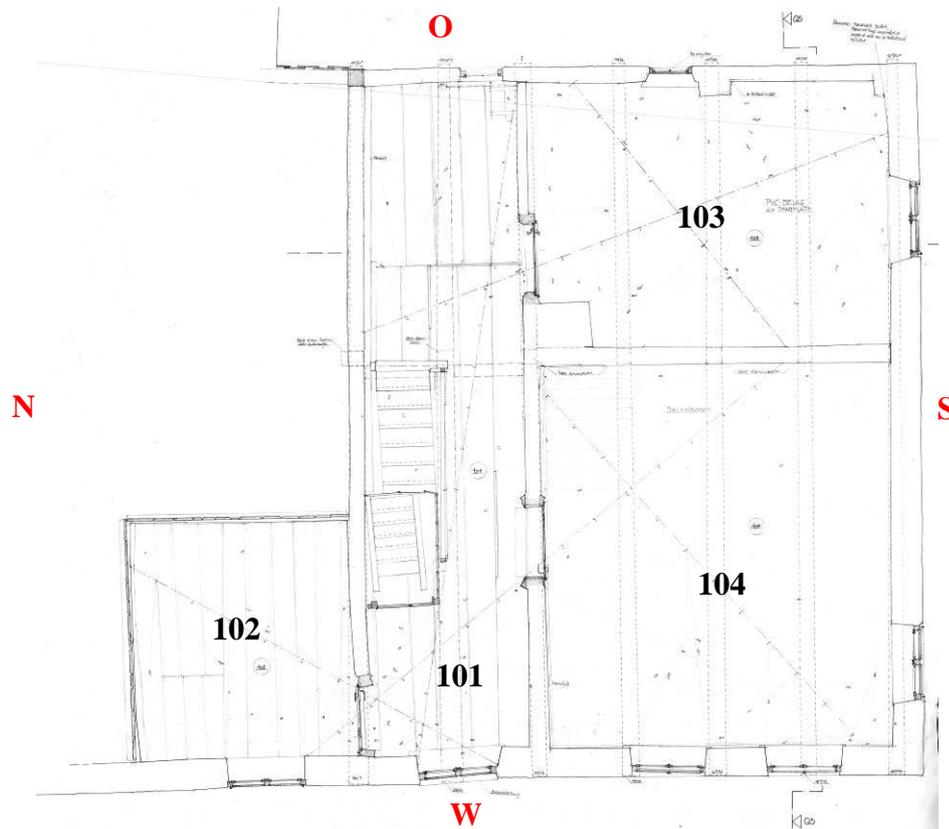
Ausschnitt aus dem Grundriß des Obergeschoss (Wohnteil)
